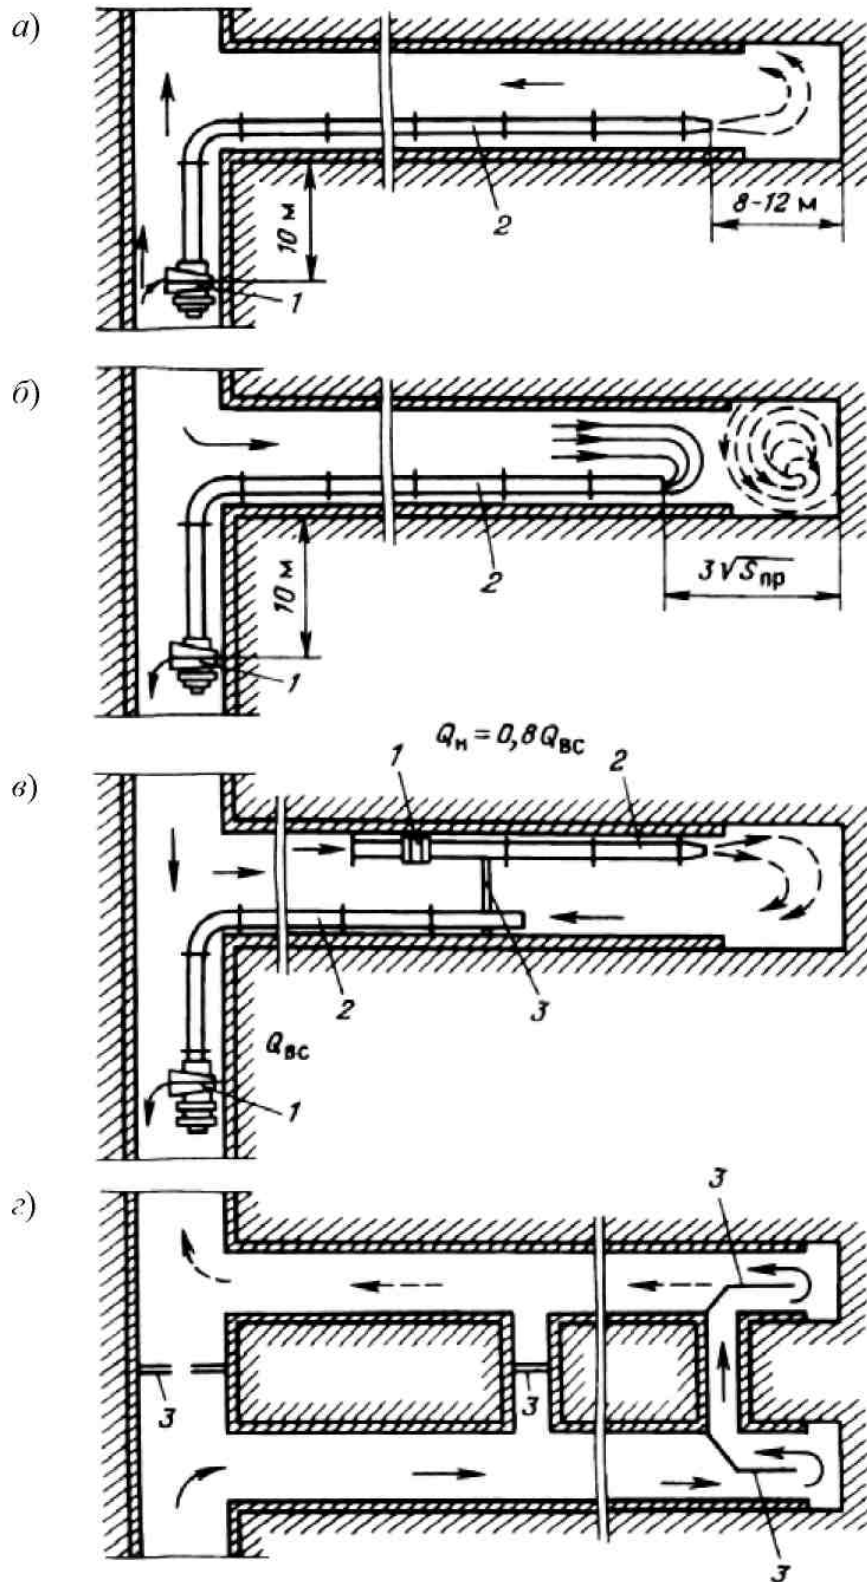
Способы проветривания тупиковых выработок: а) нагнетательный; б) всасывающий; в) комбинированный; г) с использованием параллельной выработки; 1 – вентилятор местного проветривания; 2 – вентиляционный трубопровод; 3 – вентиляционная перемычка
